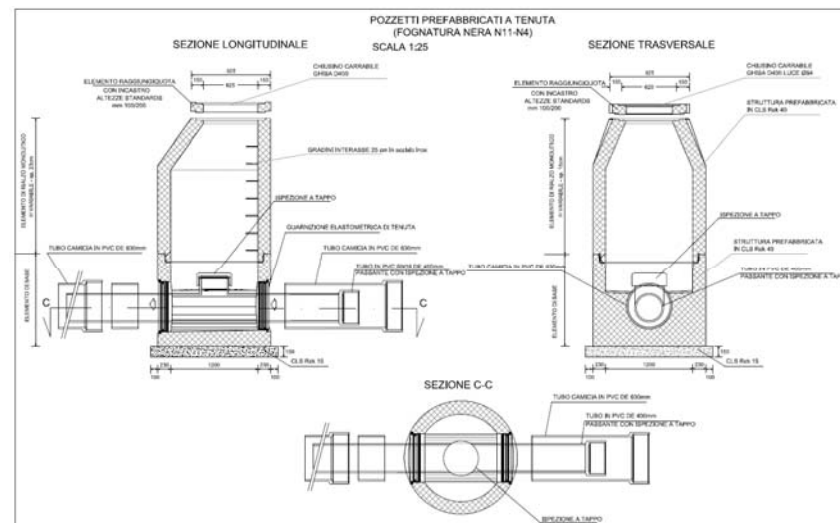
Pozzetti prefabbricati a tenuta nel tratto di interferenza con la zona di rispetto allargata
